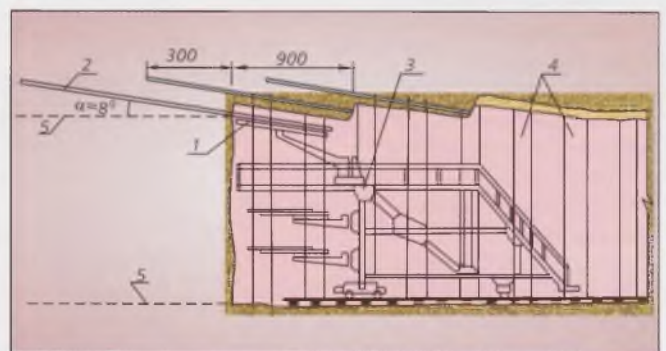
Устройство наклонных перекрывающихся экранов из труб: 1 – буровой станок; 2 – трубы защитного экрана; 3 – буровая рама; 4 – арочно-бетонная крепь; 5 – контур выработки
